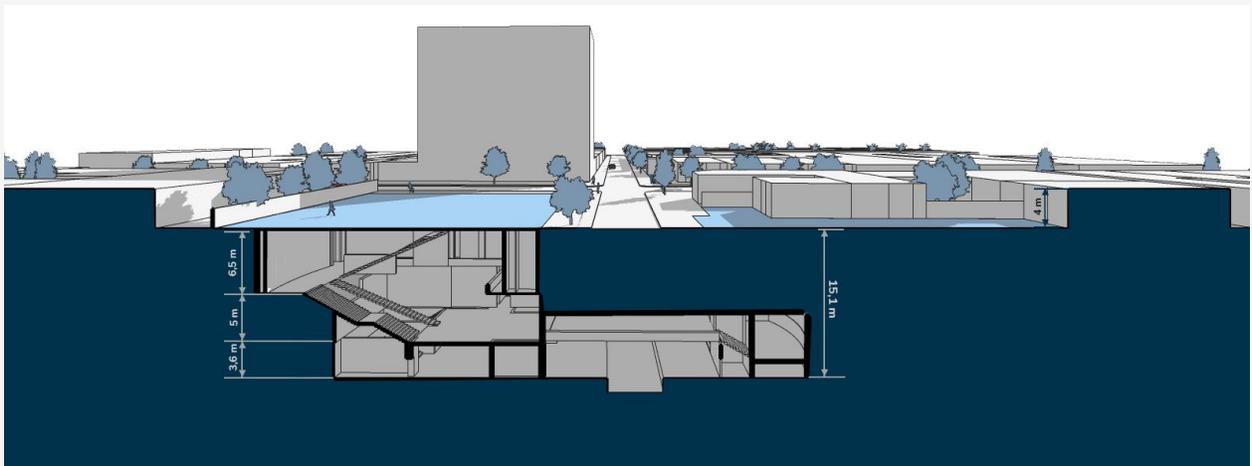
Corte longitudinal "2", situación actual Fuente: Elaboración propia.
